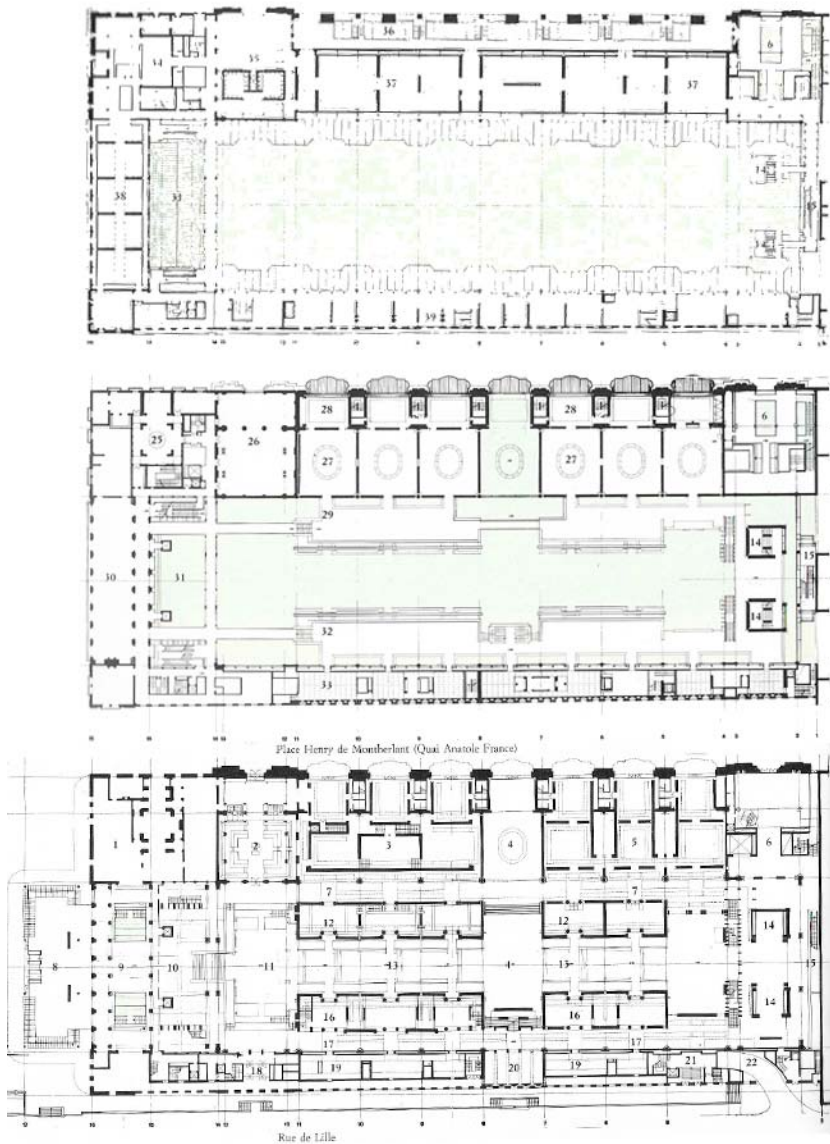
Plantas generales (en orden de abajo a arriba: Planta baja, primera y segunda)
